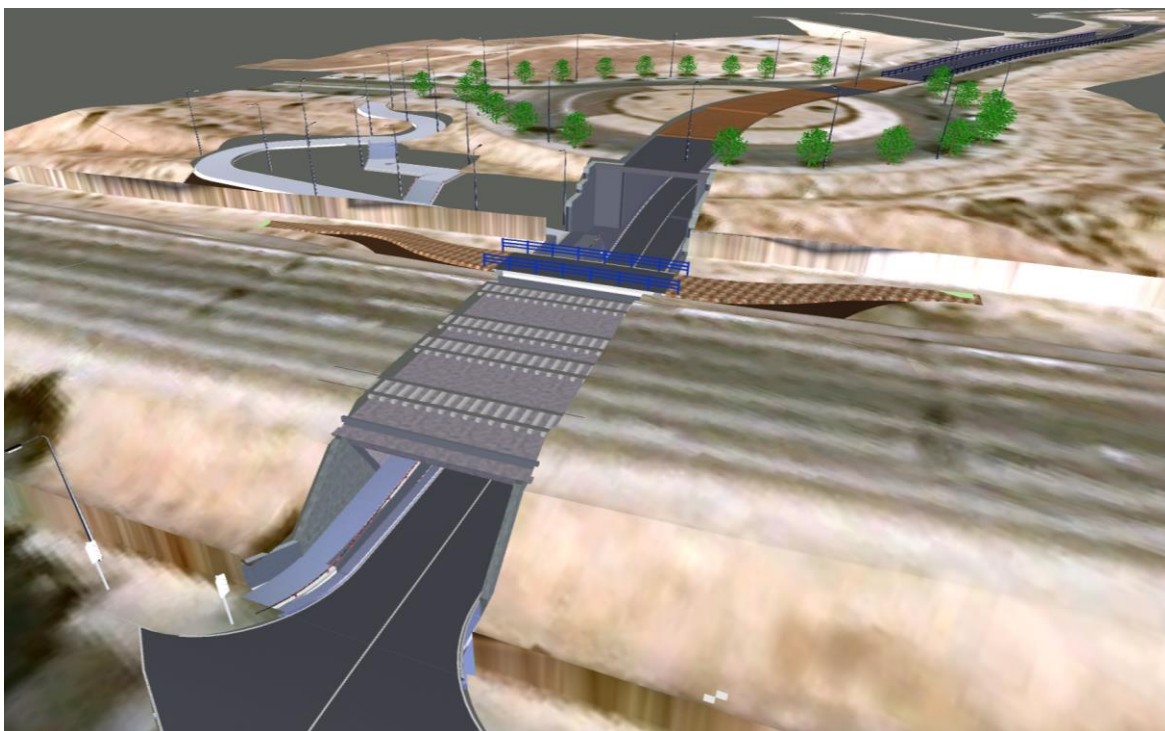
Vista del paso inferior bajo la plataforma ferroviaria.
